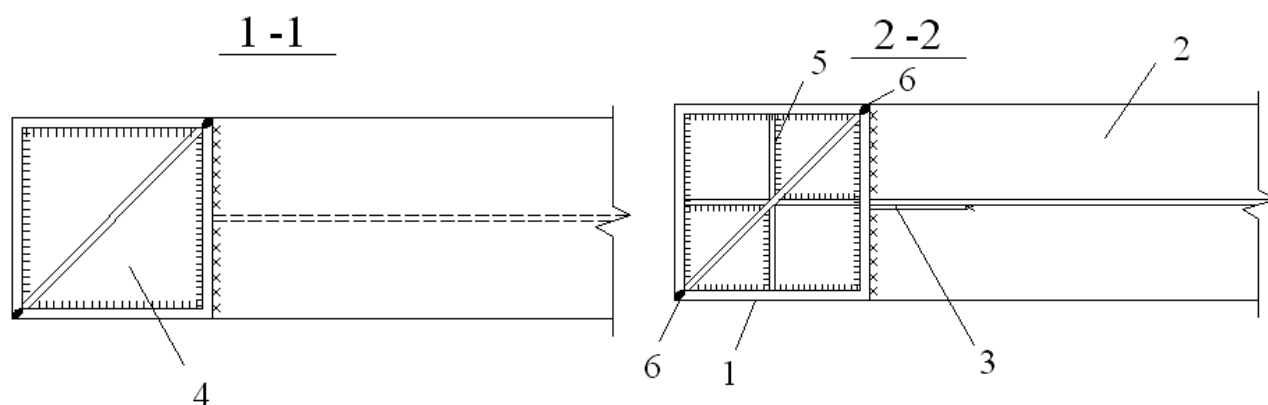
а. Разрезы 1-1, 2-2 рамного узла. 1- колонна коробчатого сечения; 2 - ригель; 3 - шпальник; 4 - треугольная диафрагма ; 5 - вертикальное ребро; 6 - продольные сварные швы, соединяющие треугольные половины колонны
